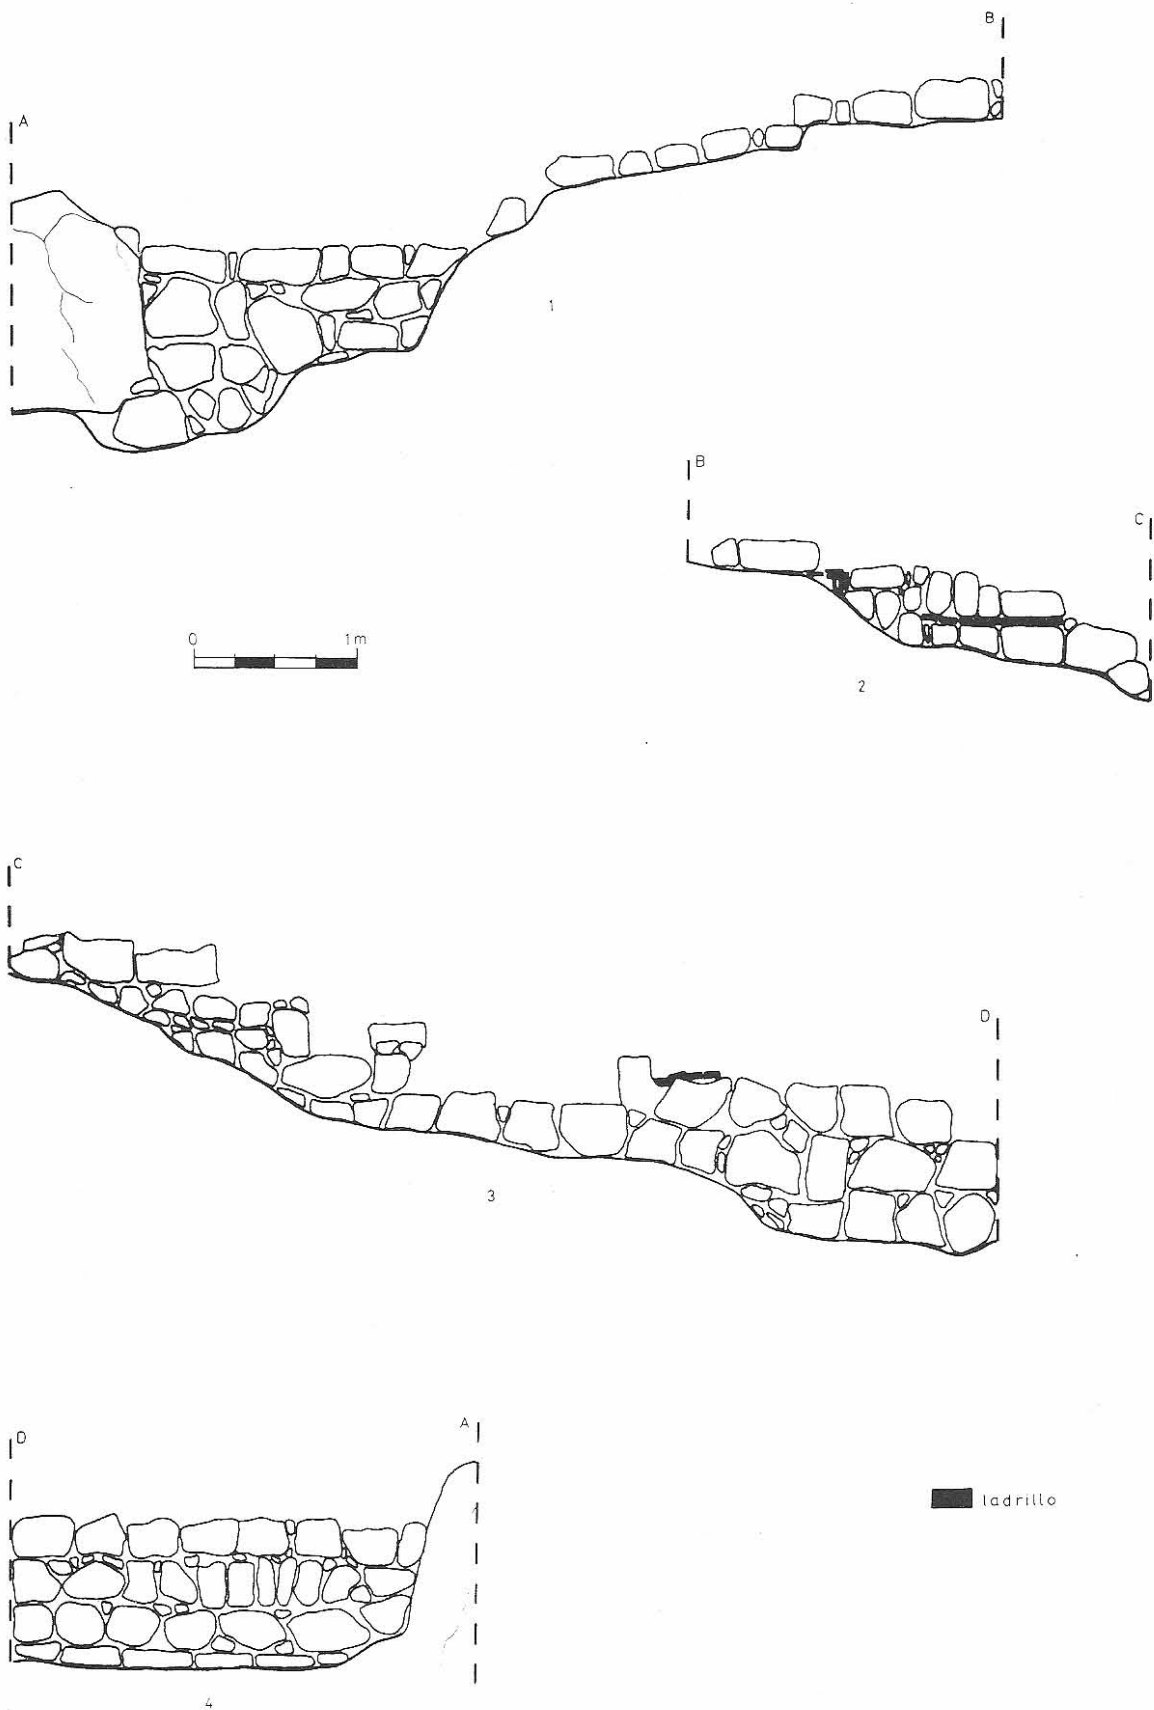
Alzados de los muros, vistos desde el interior, del sector 1. 1. Muro norte. 2. Muro este. 3. Muro sur. 4. Muro oeste.
